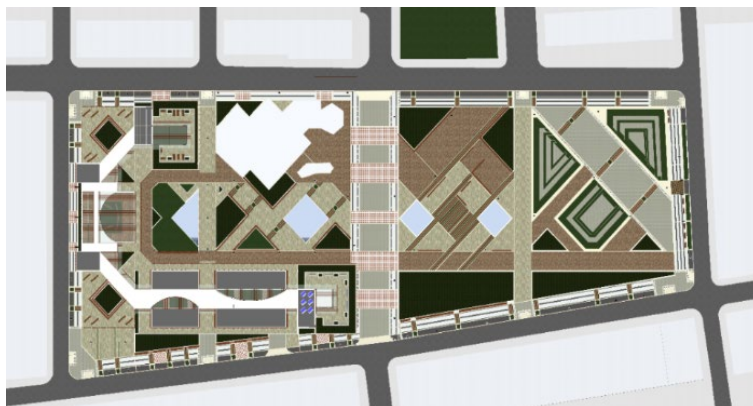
Planta de cubiertas -Módulos sobre plataforma transitable
